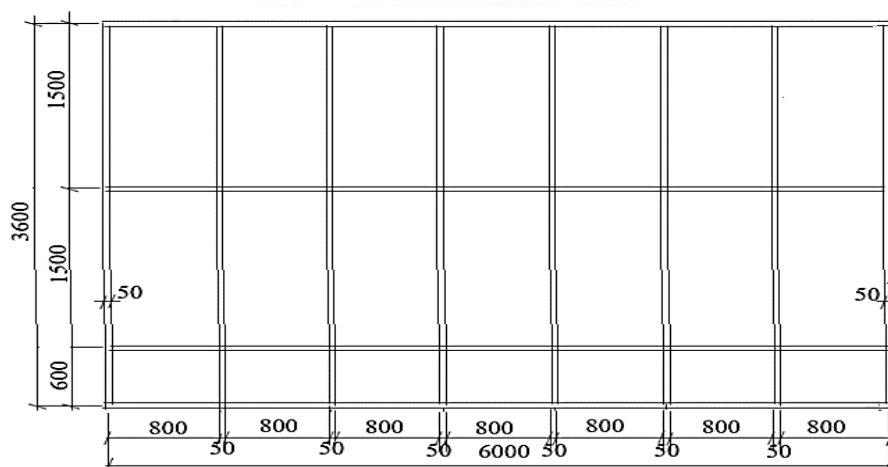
Схема каркаса ячейки светопрозрачного фасада
